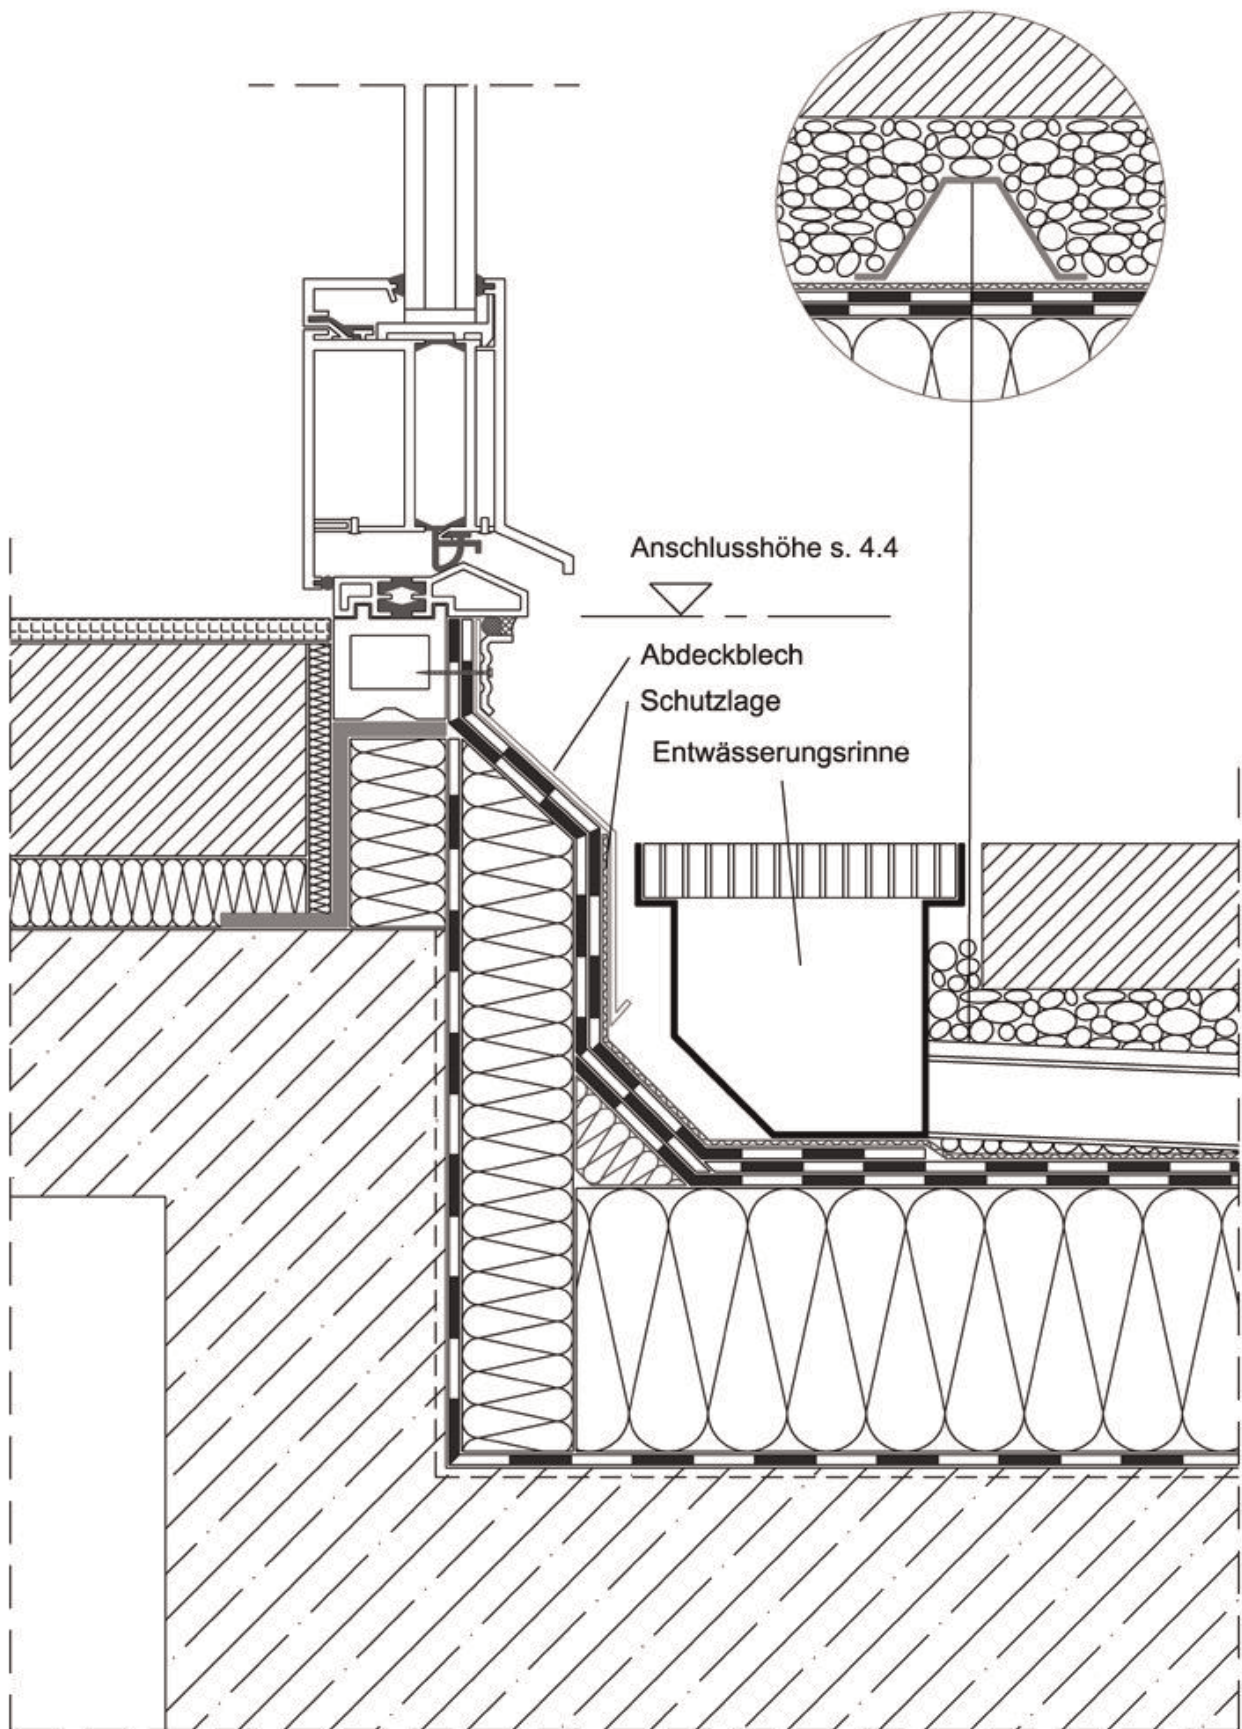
Terrassentüranschluss mit Entwässerungsrinne – Ausführung mit Bitumenbahnen
